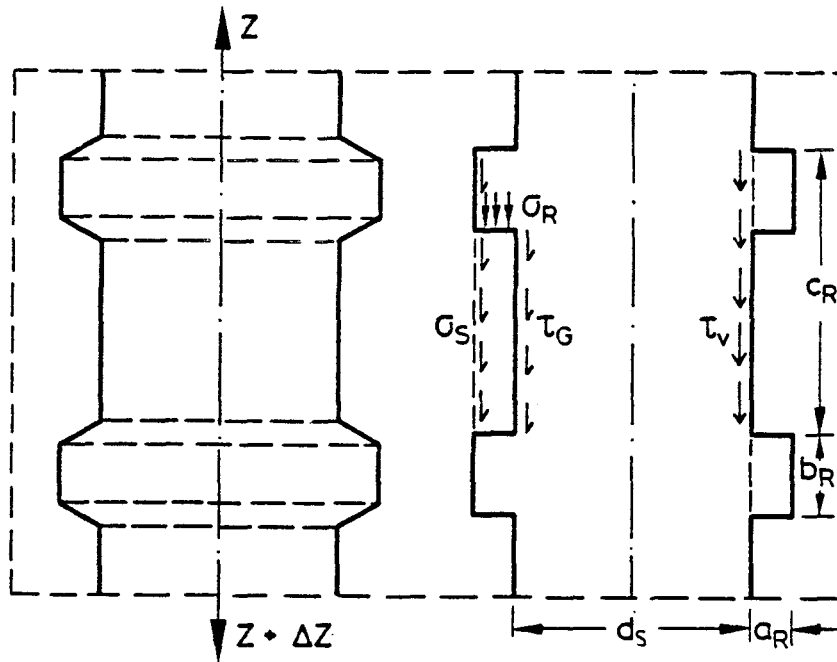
Idealisierter Bewehrungsstab und innere Kräfte gegen den Beton
